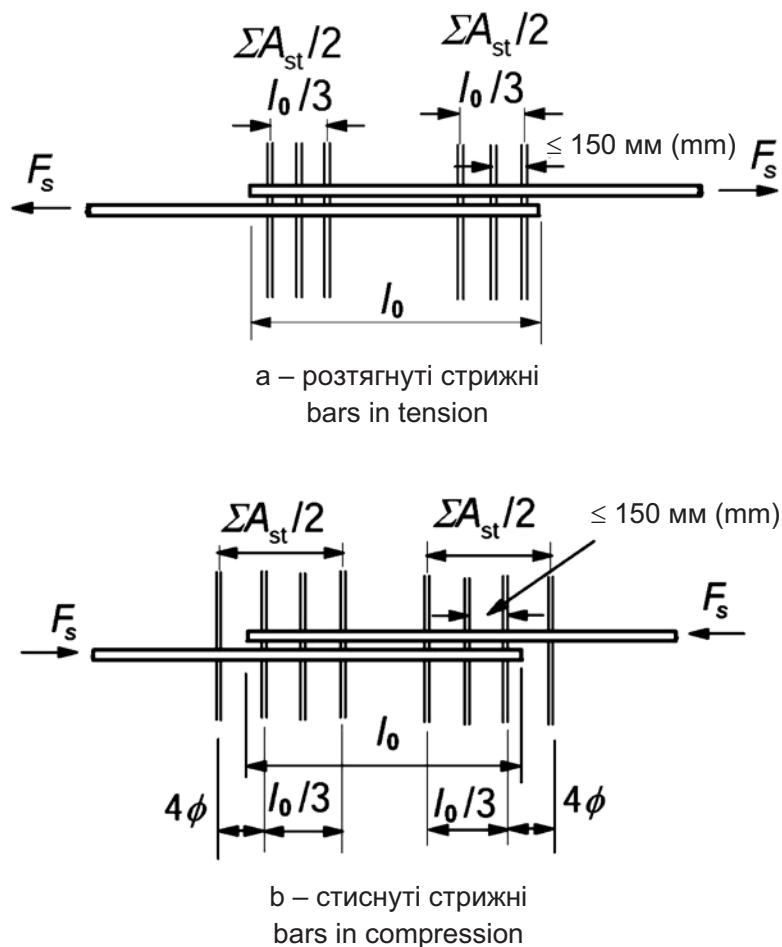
Поперечне армування для з'єднань унапуск
